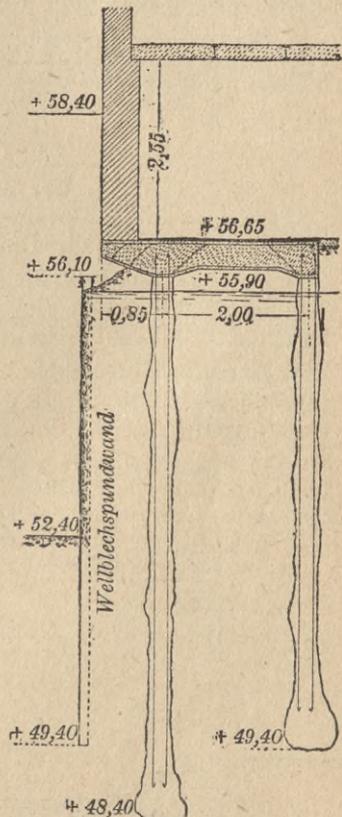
Unterfangen einer Giebelmauer mittels Eisenbeton-Kragplatte auf Ortpfählen.
